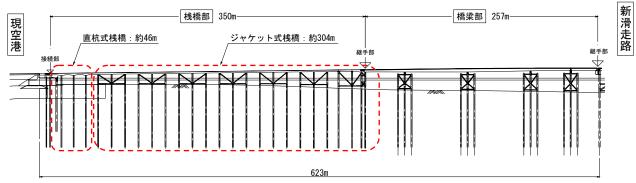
連絡誘導路 側面図 (図-1の A-A 断面)
